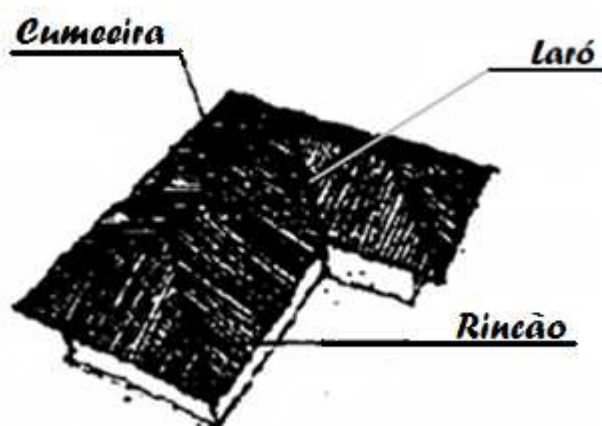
Esquema construtivo de um telhado irregular (Fonte: Manual de conservação de telhados, 1999, adaptado).
